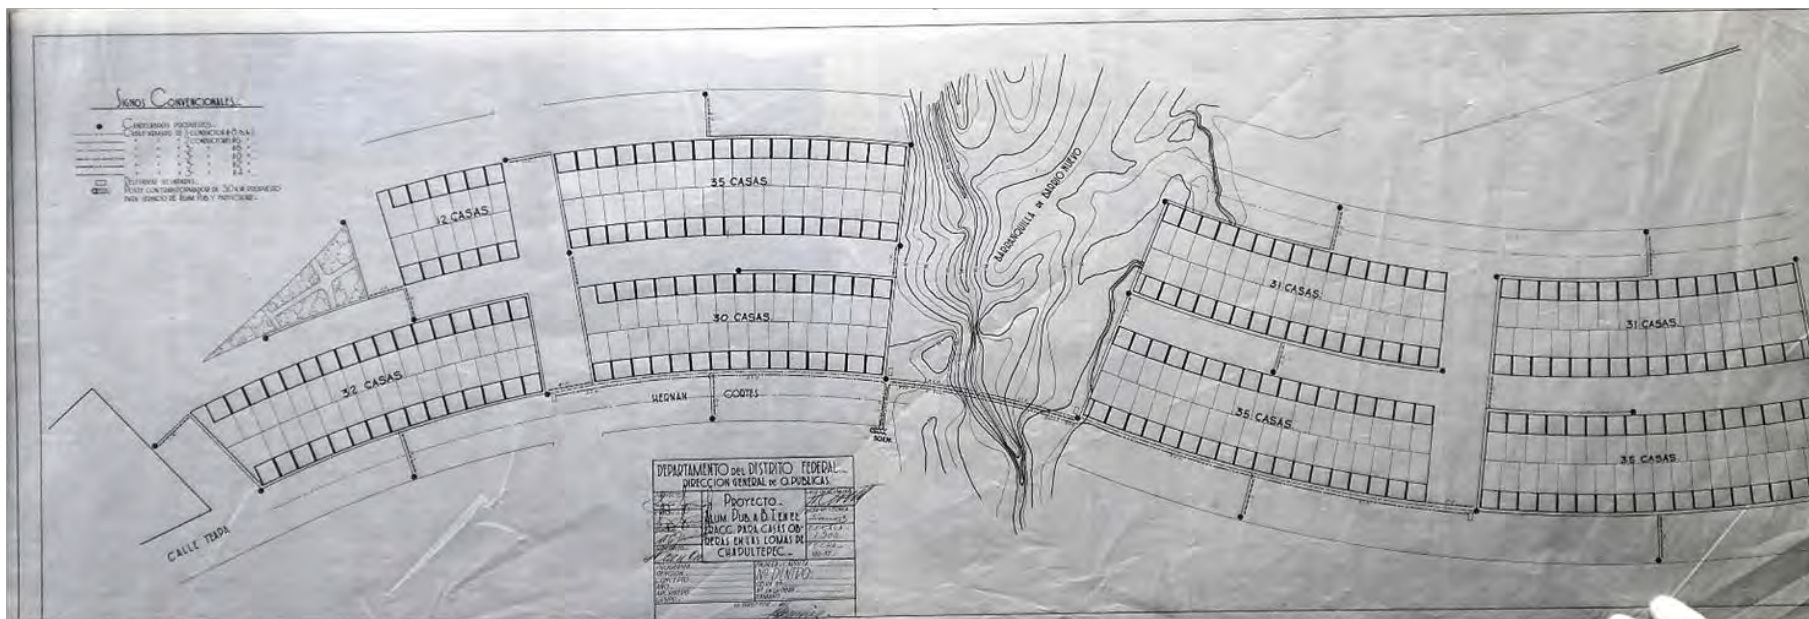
Plano del sembrado de las viviendas obreras en las Lomas de Chapultepec, construidas por el Departamento del Distrito Federal.
